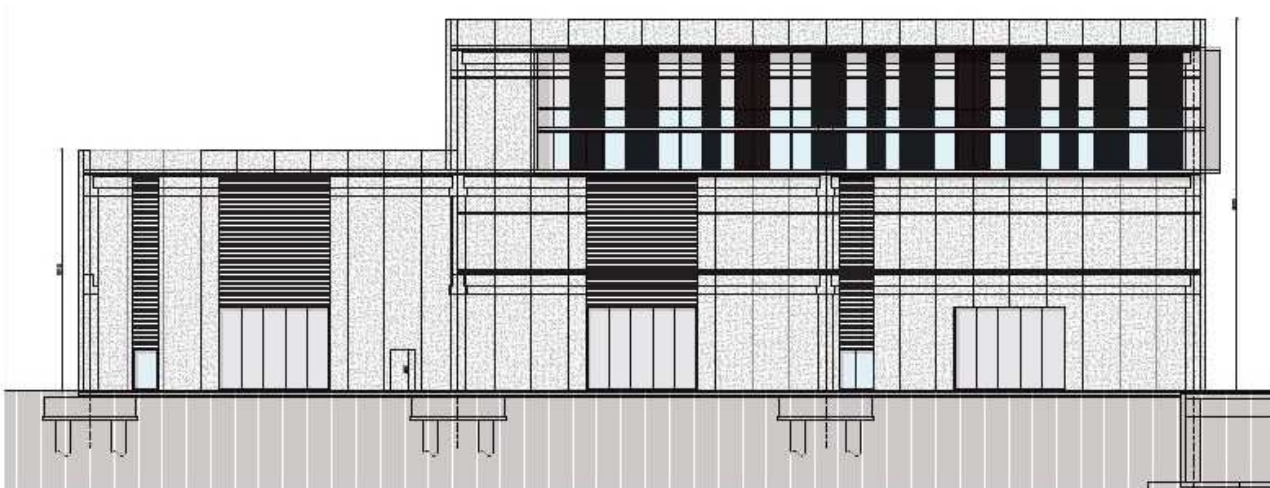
Edifici 2 e 3 Prospetto Ovest
